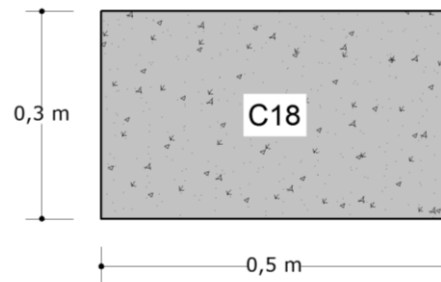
Dimensiones de la columna, Elaboración Propia
